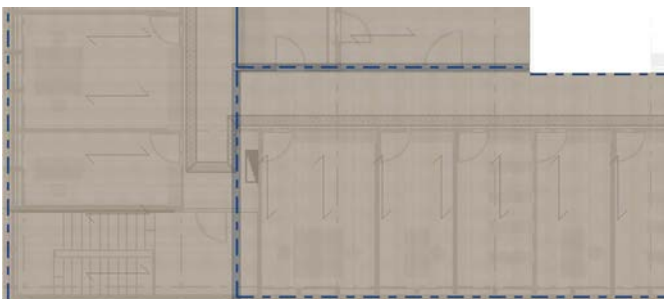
Ausschnitt Grundriss 1. OG, Spannrichtungswechsel Grundrissecke (Quelle: B + G)
